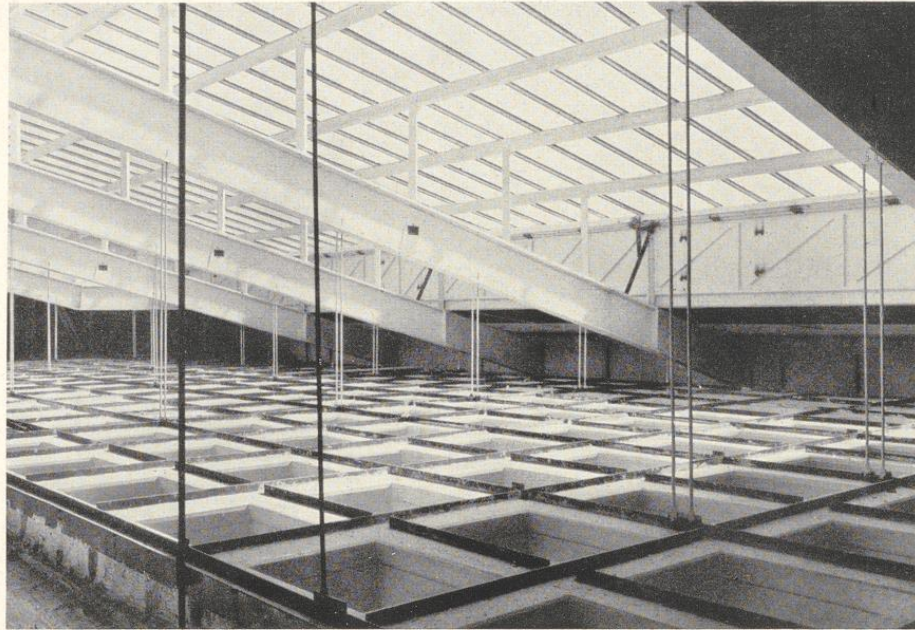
Stuckdecke mit Oberlicht im Guß- und Setzverfahren ausgeführt. Oberste Baubehörde München. Ausführung Stuckgeschäft Fritz Bender, München
